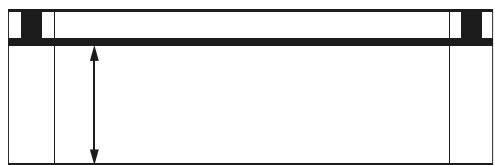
Losa se ubica en la parte inferior de la losa. Observar que se tiene una altura menor. Se puede utilizar el relleno para instalaciones o jardinería. Se debe fundir base de concreto para piso.
